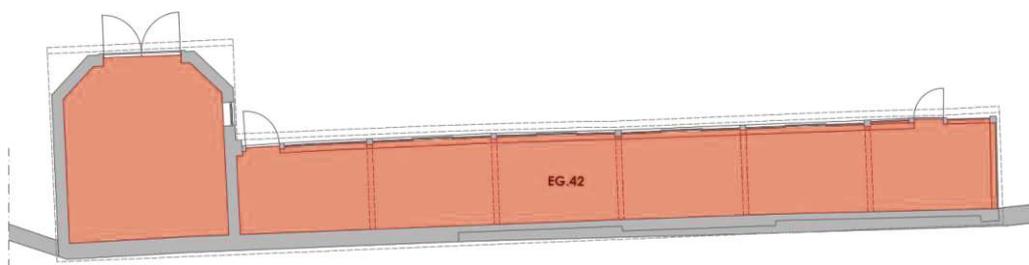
Erdgeschoss Übersichtsplan- EG.42
